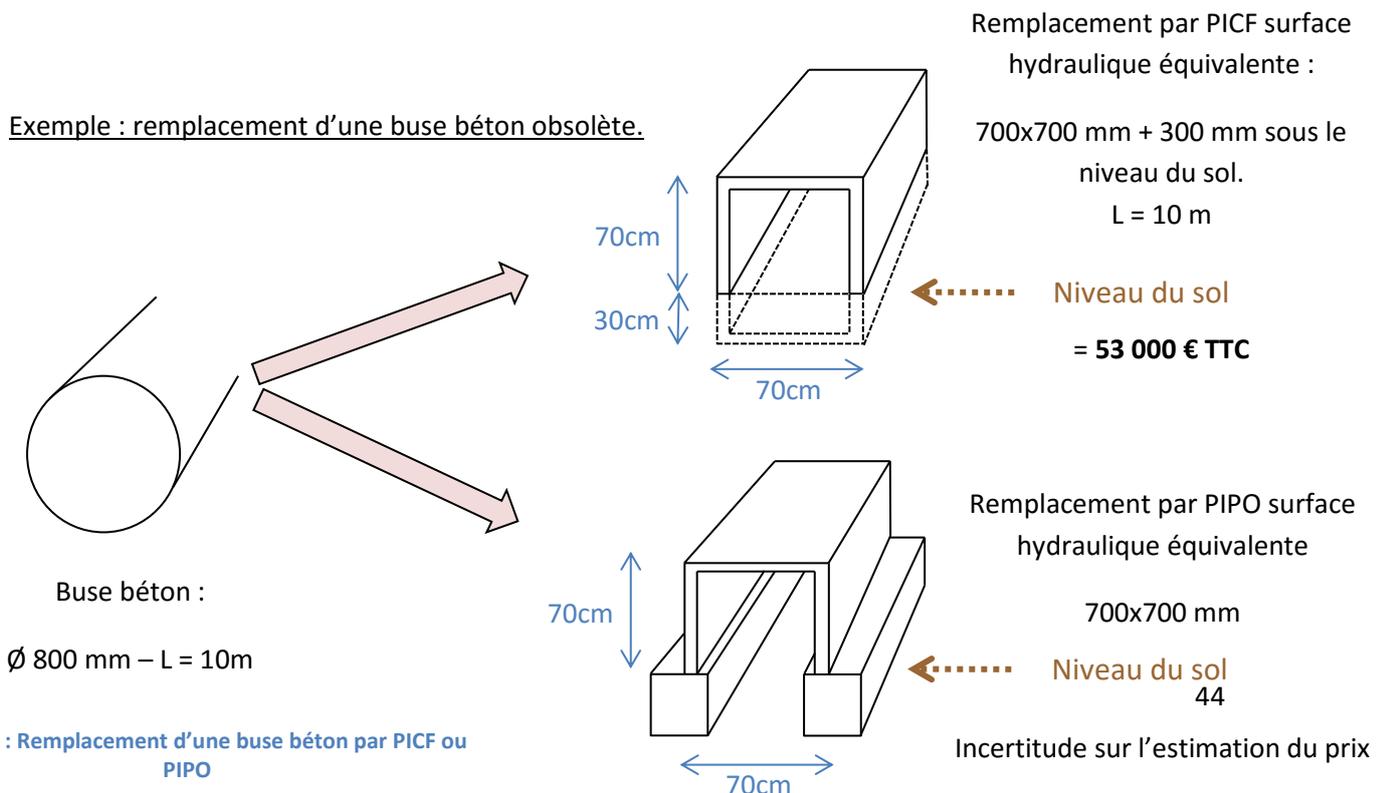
Remplacement d'une buse béton par PICF ou PIPO
